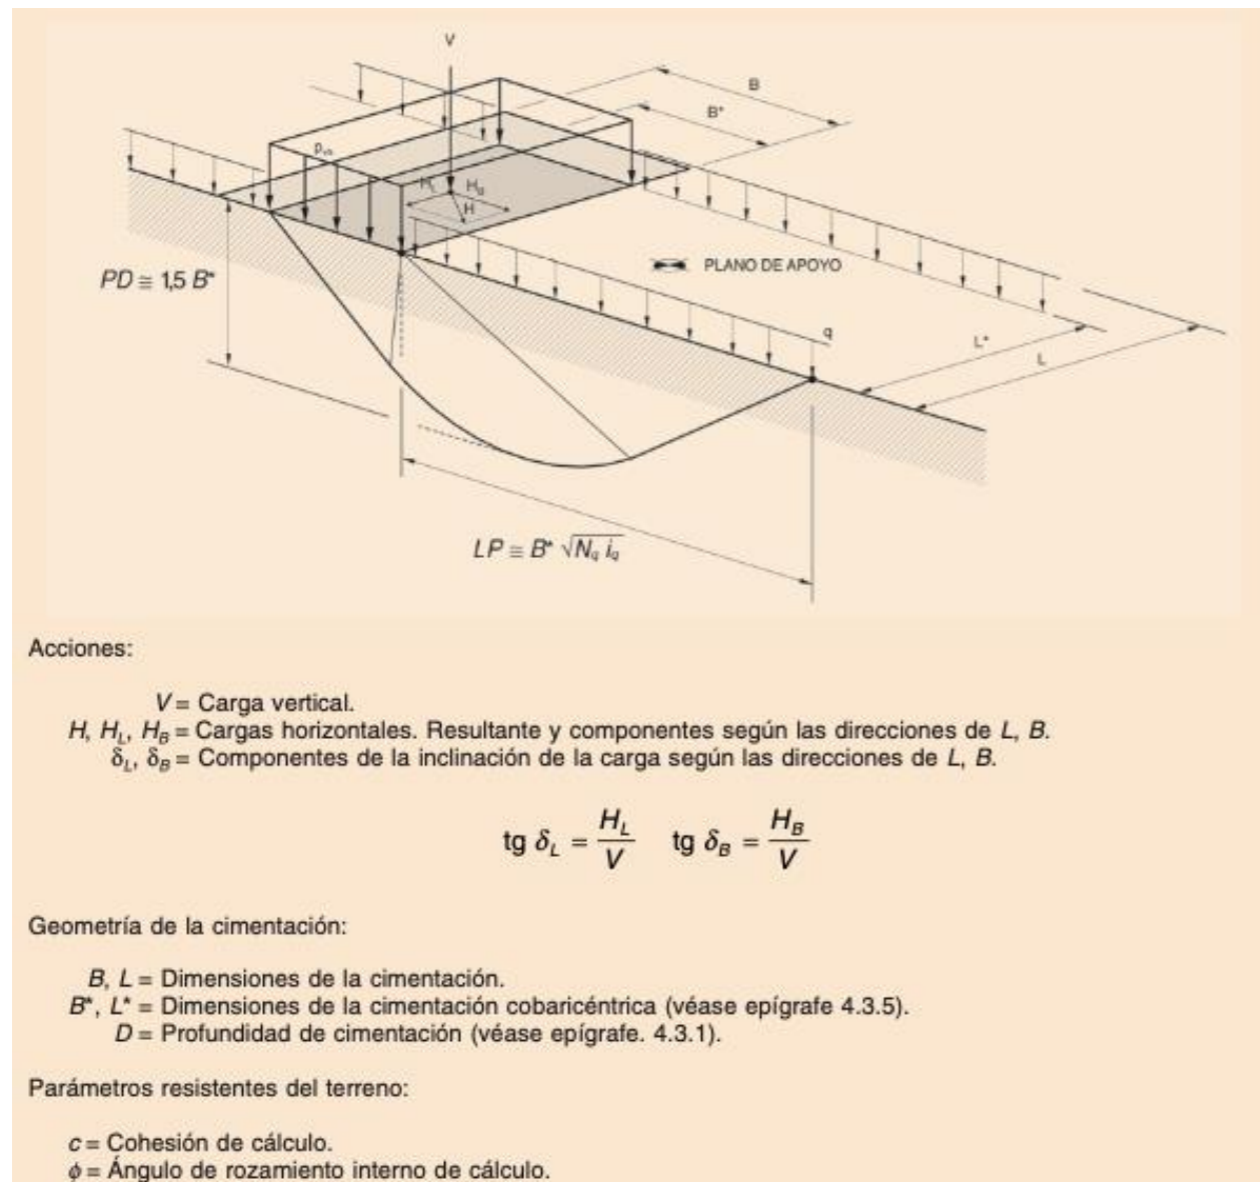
Esquema de cimentación tipo. Guía de cimentaciones en obras de carretera.
